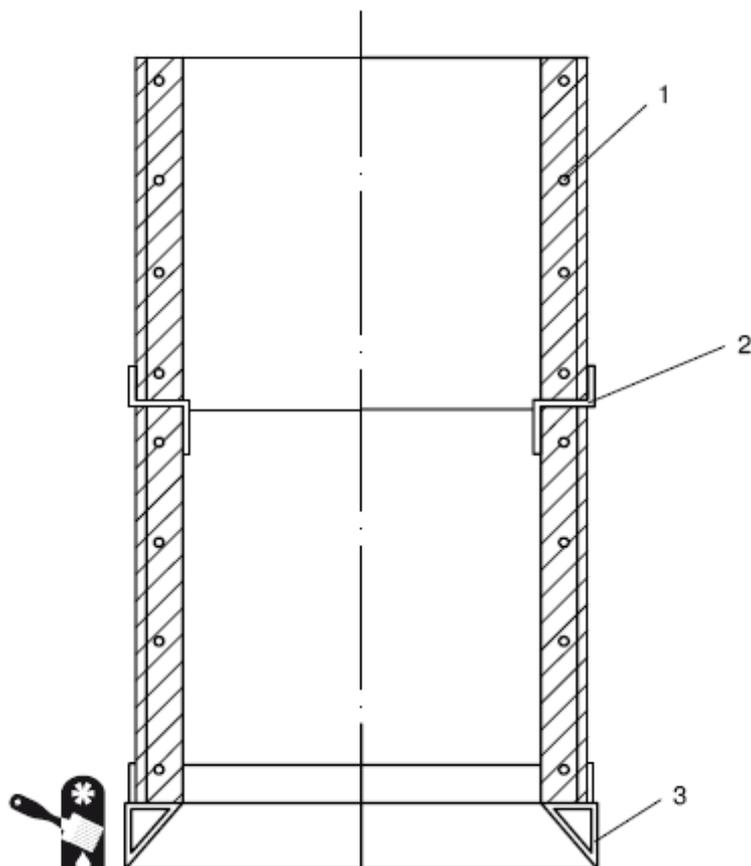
Устройство бетонного колодца: 1 – арматура; 2 – скоба; 3 – башмак
